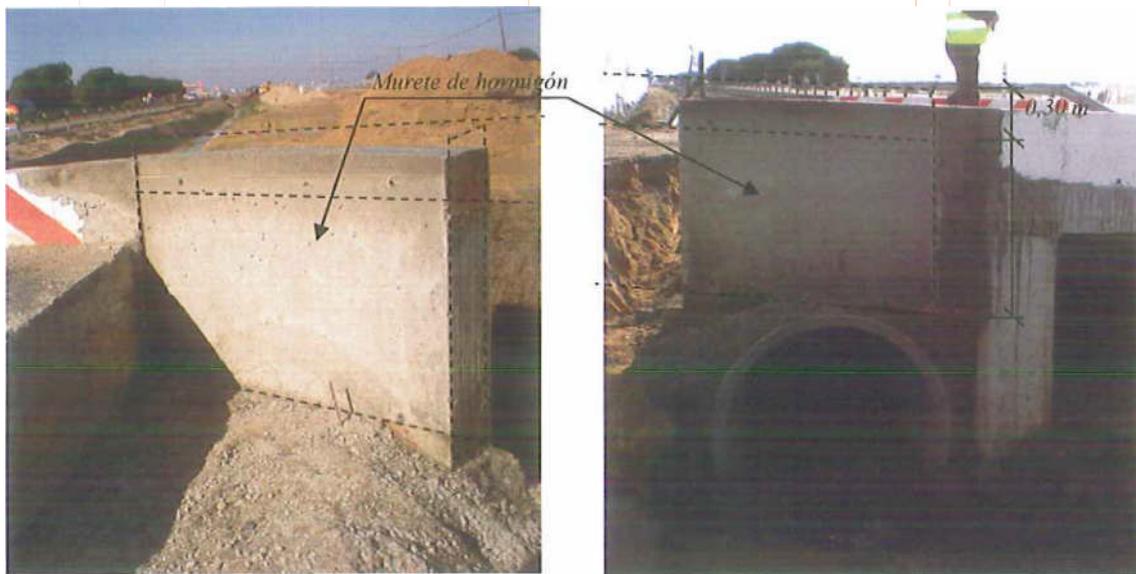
Vista interior (desde el puente) y exterior (desde el badén) del murete de hormigón.
